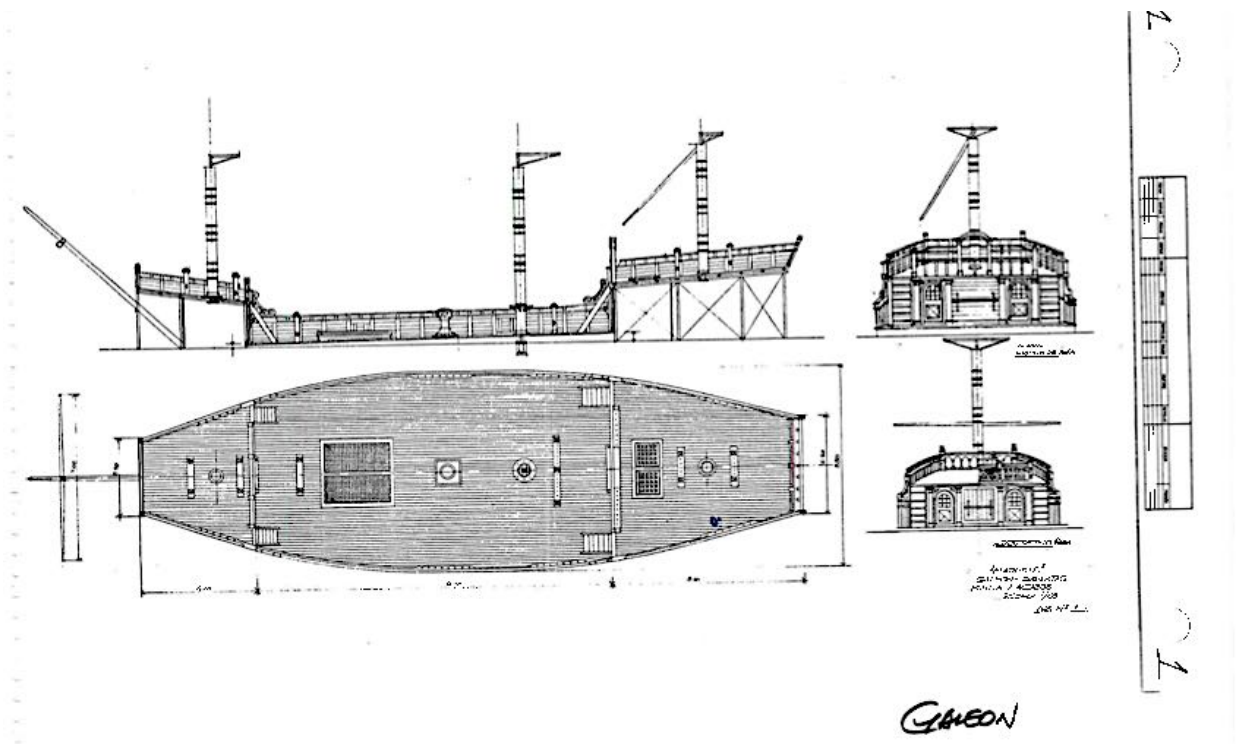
Plano. Planta y alzados. Galeón cubierta. *Alatriste*.
